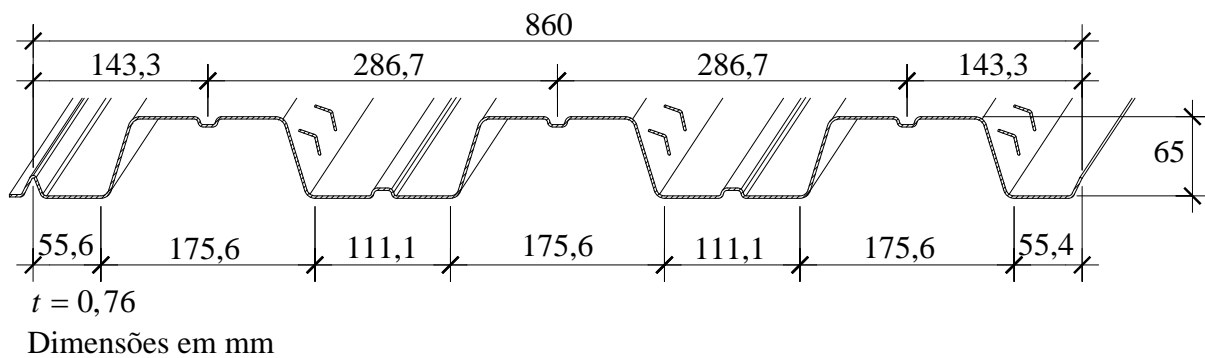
Dimensões do perfil de aço *Steel Deck Modular* MD65.
